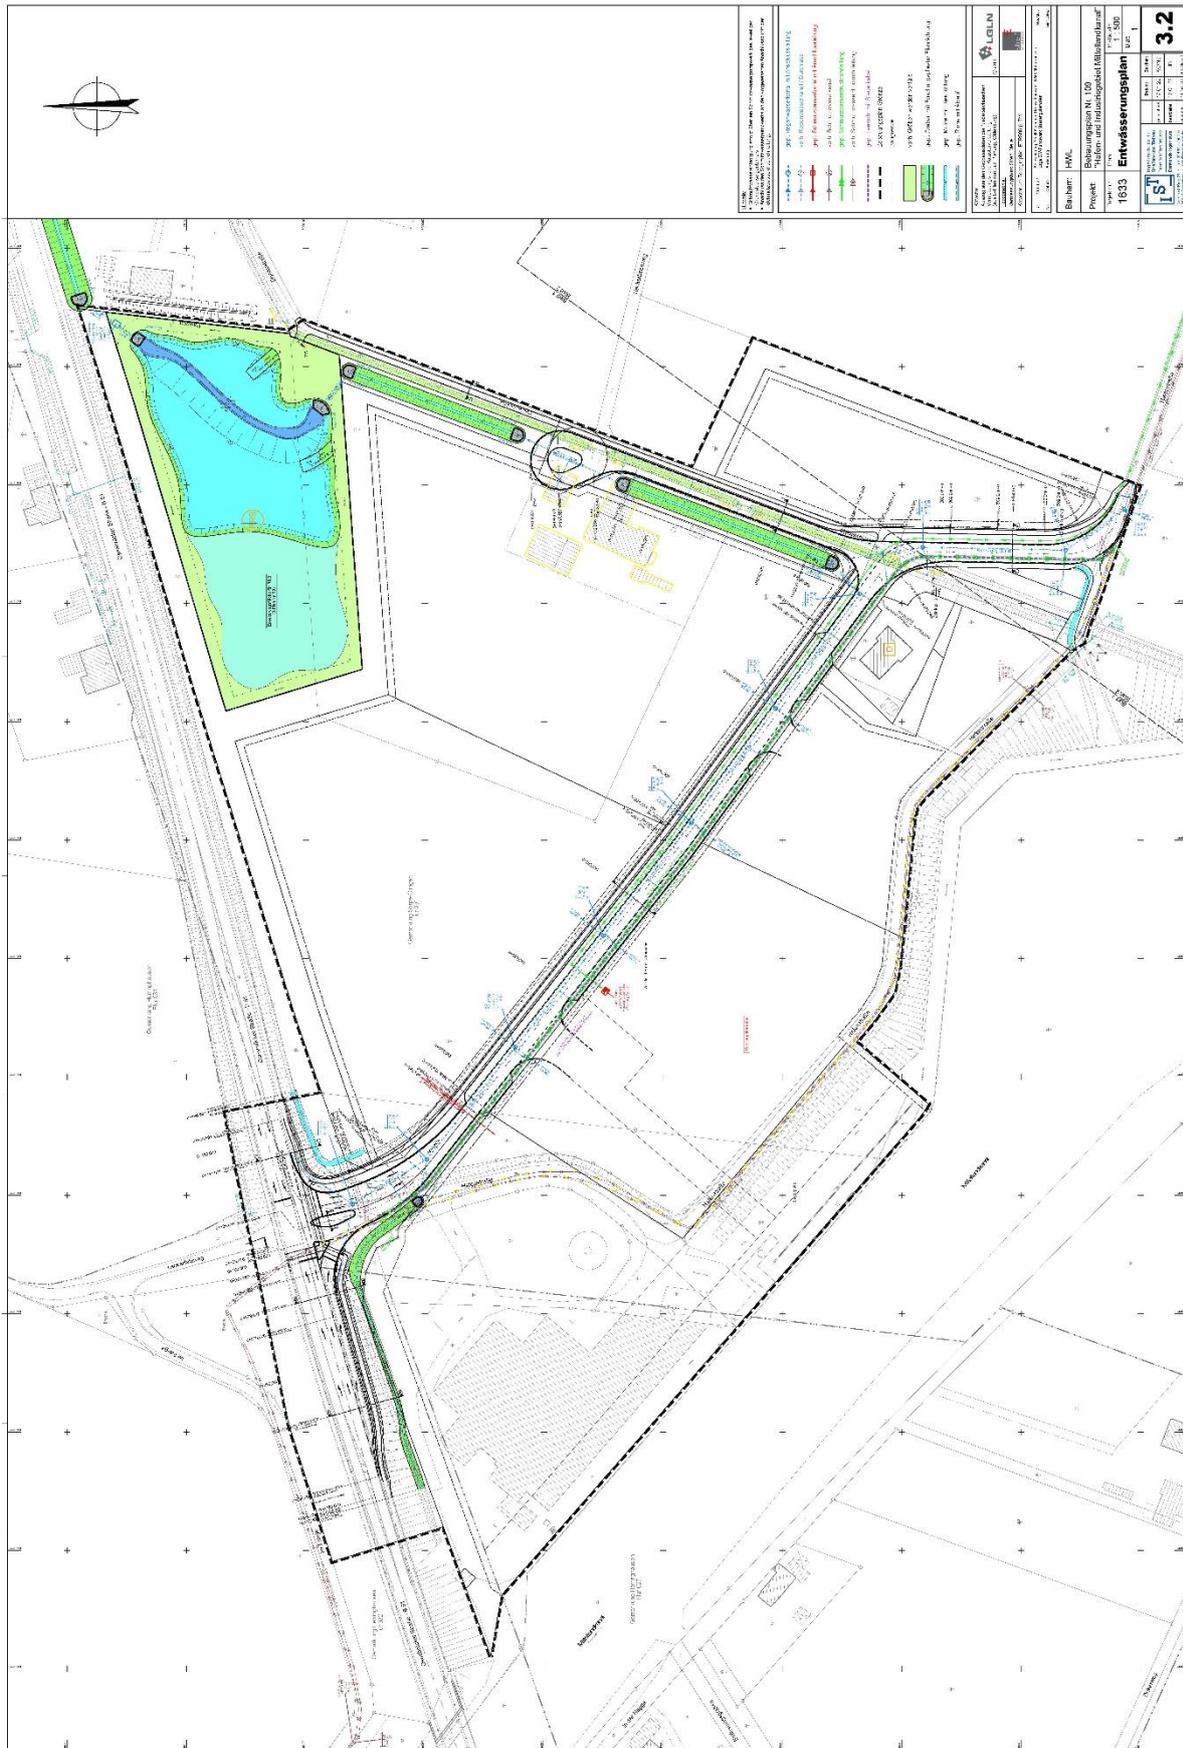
Entwässerungsplan IST – Ingenieurbüro für Straßen und Tiefbau, Schortens vom Juli 2022
